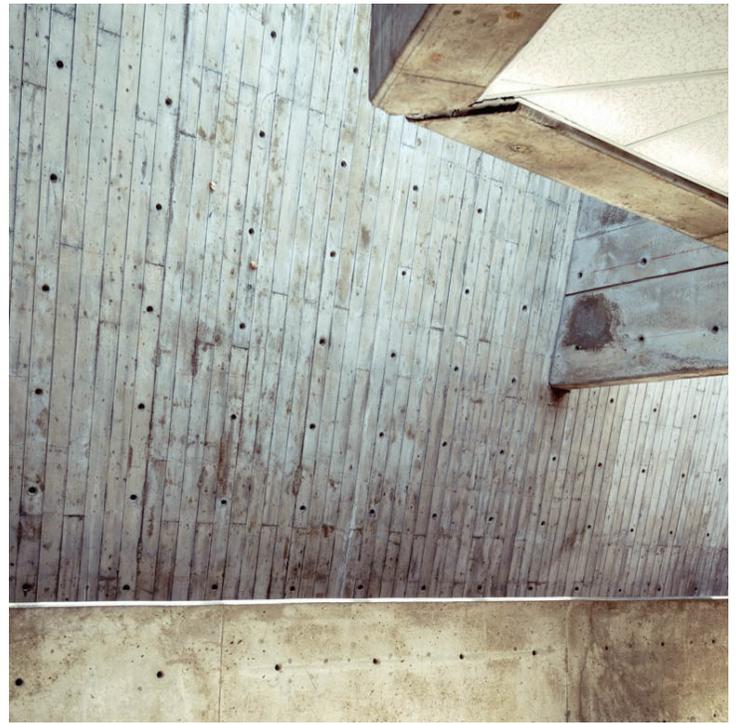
, Andrews Building, Arq. John Andrews, Fotografía por Ruta Krau.
